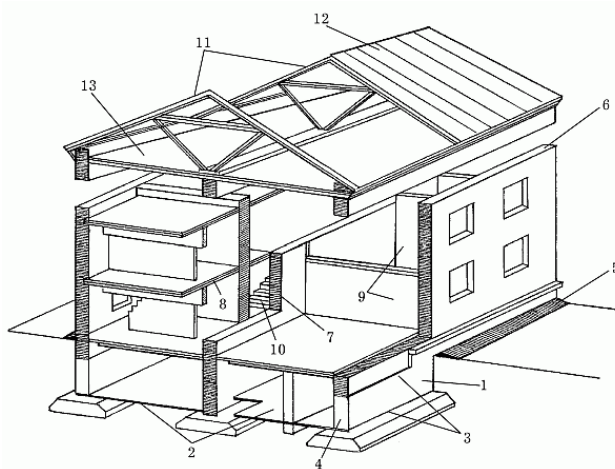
Основные конструктивные элементы здания (дом из двух этажей): 1 – фундамент; 2 – пол подвала; 3 – гидроизоляция; 4 – стены подвала; 5 – отмостка; 6 – наружные стены; 7 – внутренние стены; 8 – междуэтажные перекрытия; 9 – перегородки; 10 – лестница; 11 – стропила; 12 – кровля; 13 – чердачное перекрытие
